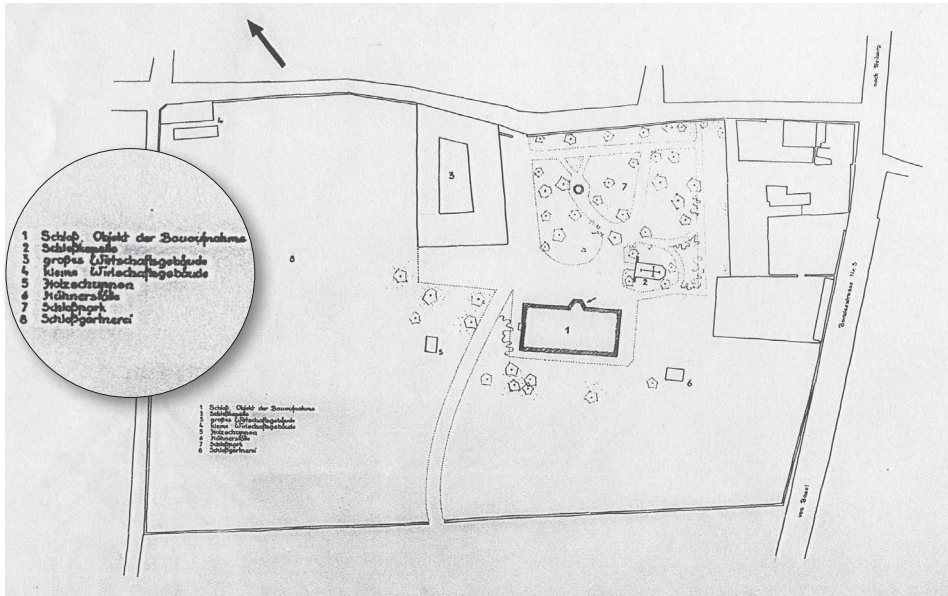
Propstei des Klosters St. Blasien in Krozingen, Lageplan
